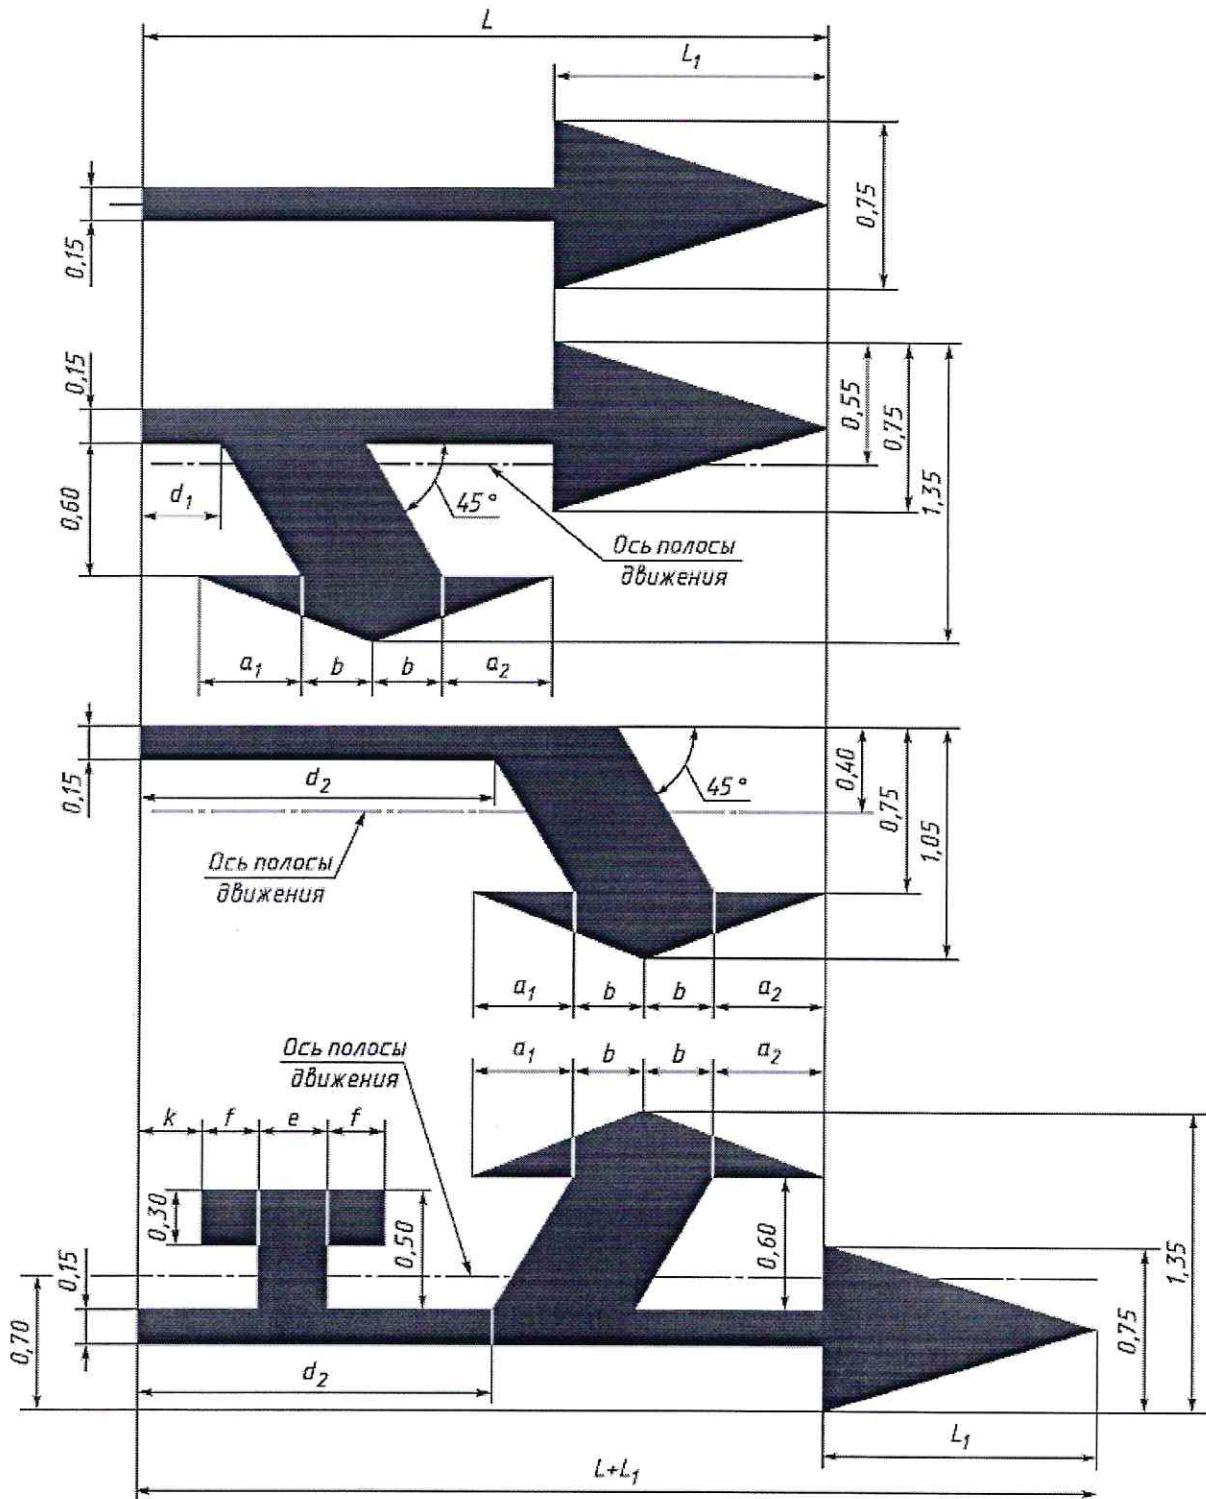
форма и размеры стрел разметки типа 1.18
